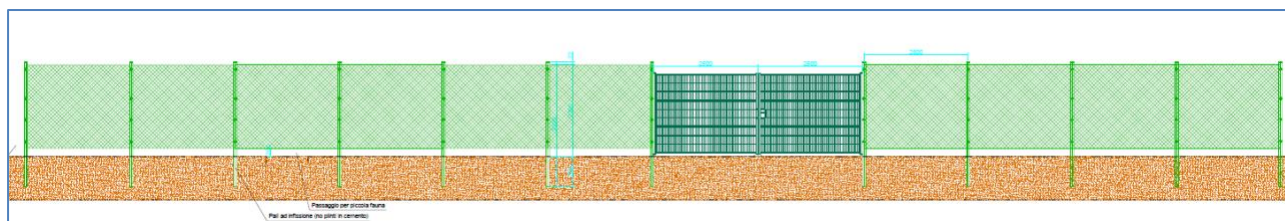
Dettaglio d'insieme della recinzione perimetrale con cancello di accesso all'area di impianto
